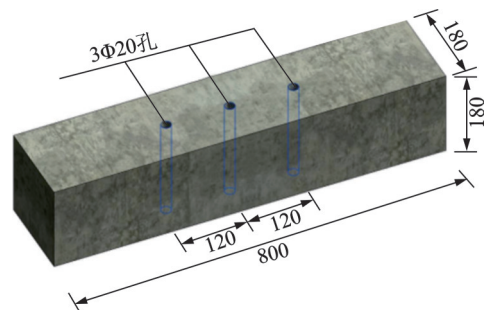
混凝土顶杆构造及尺寸示意图(单位:mm)
